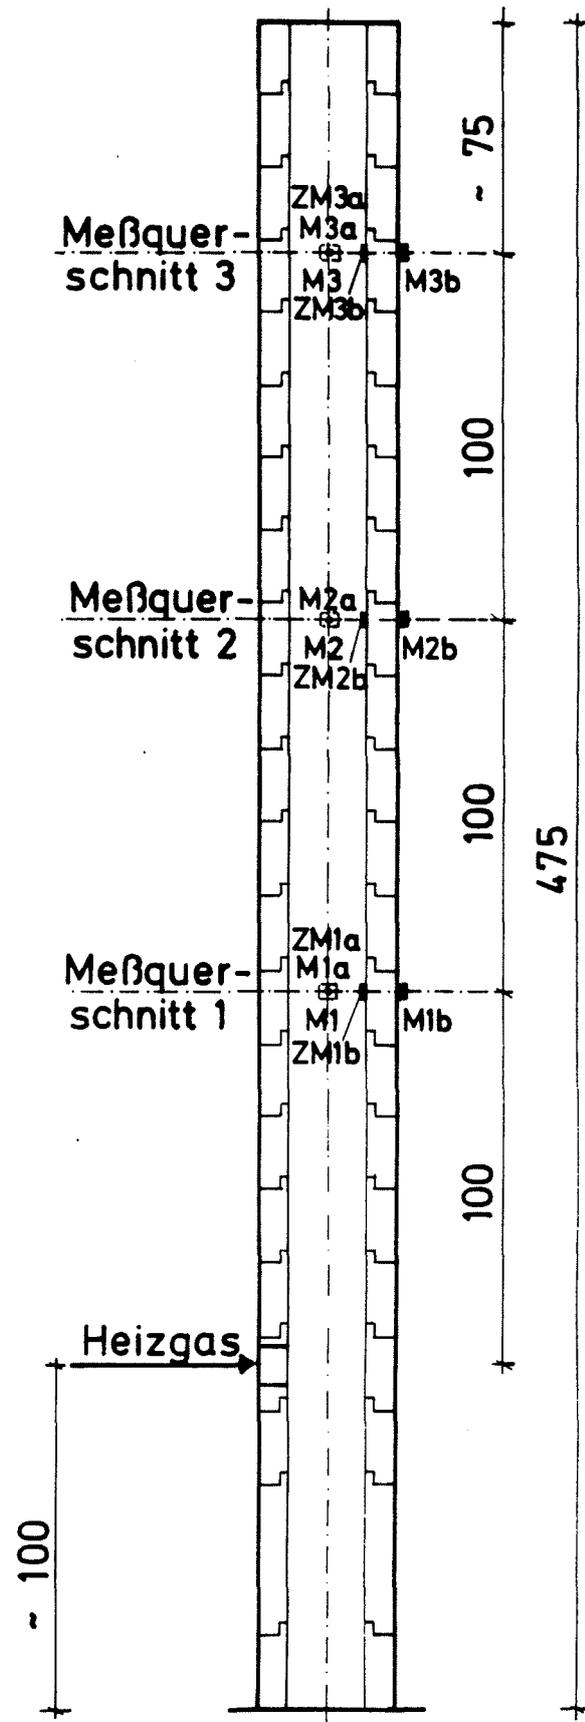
Aufbau der Prüfschornsteine des Typs B mit
